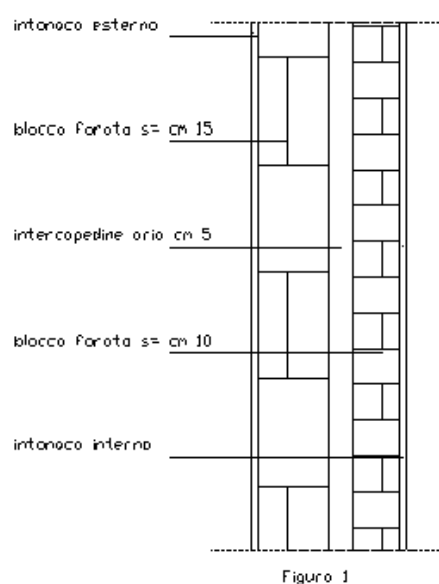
Schema strutturale delle pareti perimetrali esterne
